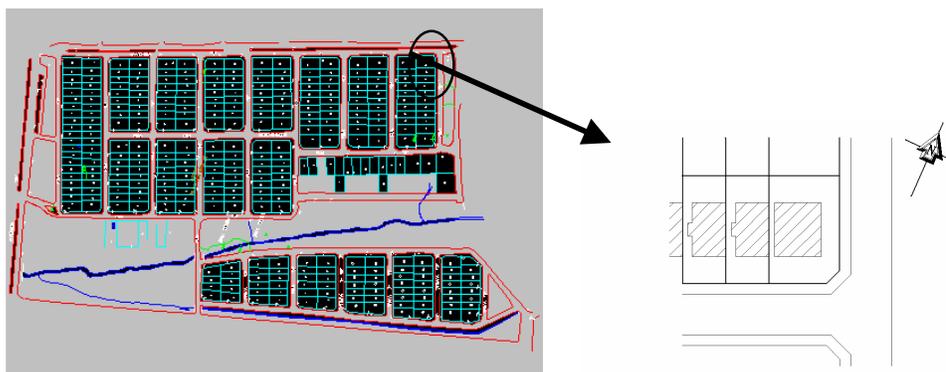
Planta do Bairro e Planta de Implantação das residências nos lotes
